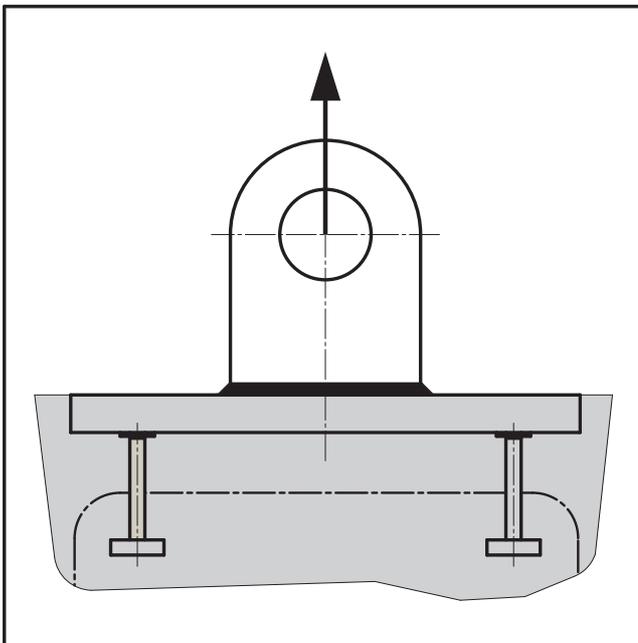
Tragöse (an einer im Beton verankerten Ankerplatte mit bauaufsichtlicher Zulassung angeschweißt)
